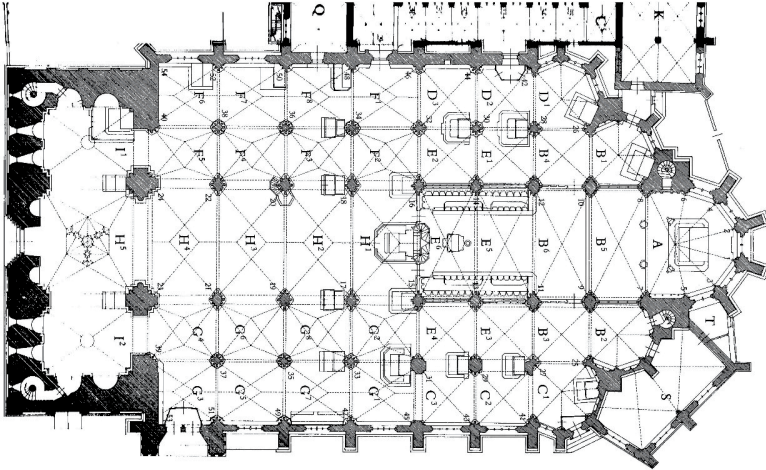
Xanten, ehemalige Stiftskirche St. Viktor, Grundriss.
